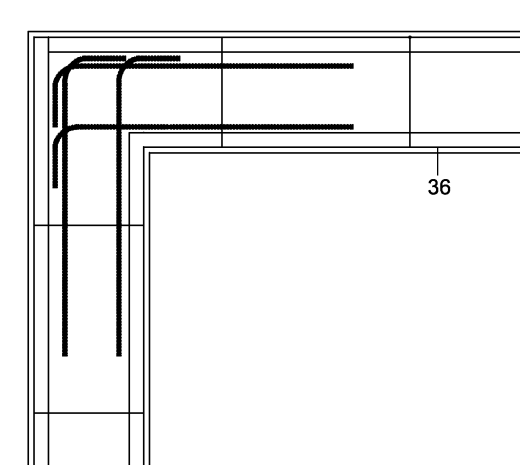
Encuentro en esquina. Armadura de zuncho por solape.
